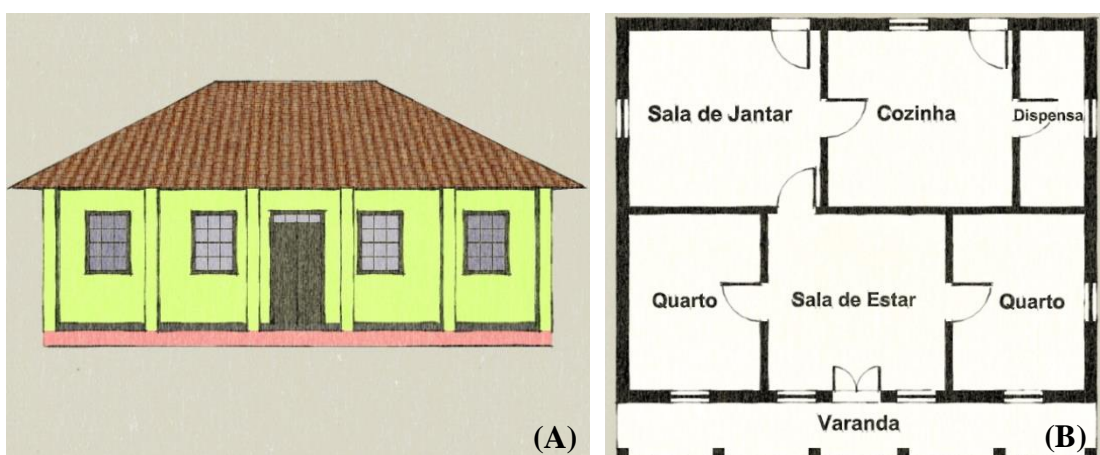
a) Fachada principal tipo 2; b) Planta baixa tipo 2.
